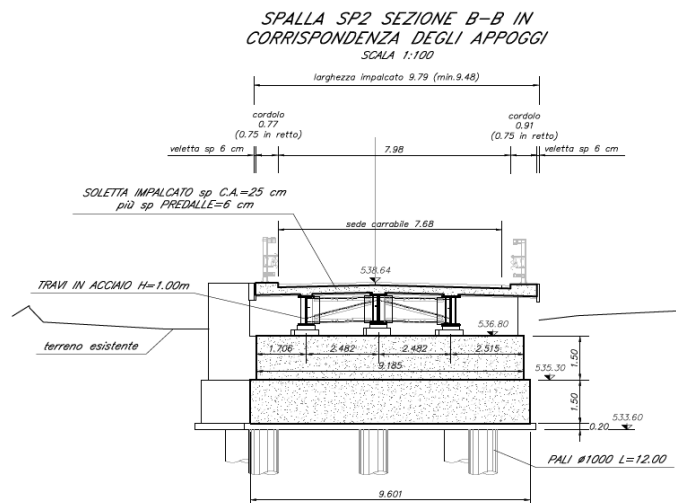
Sezione impalcato - Spalla SP2
